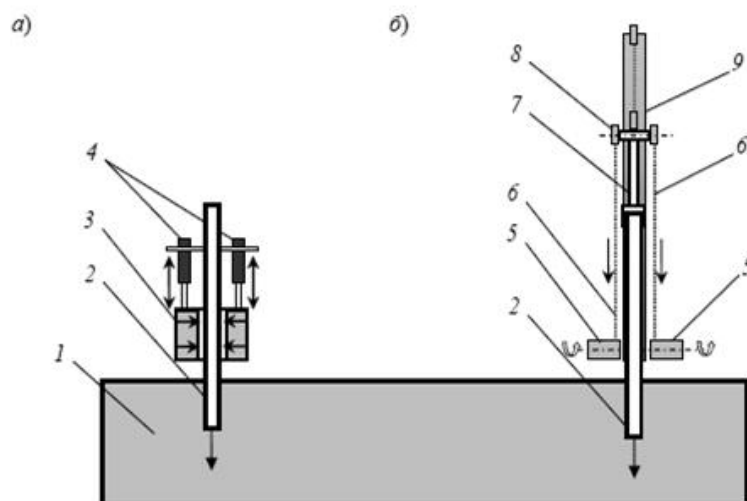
Способы передачи вдавливающего усилия на сваю:
